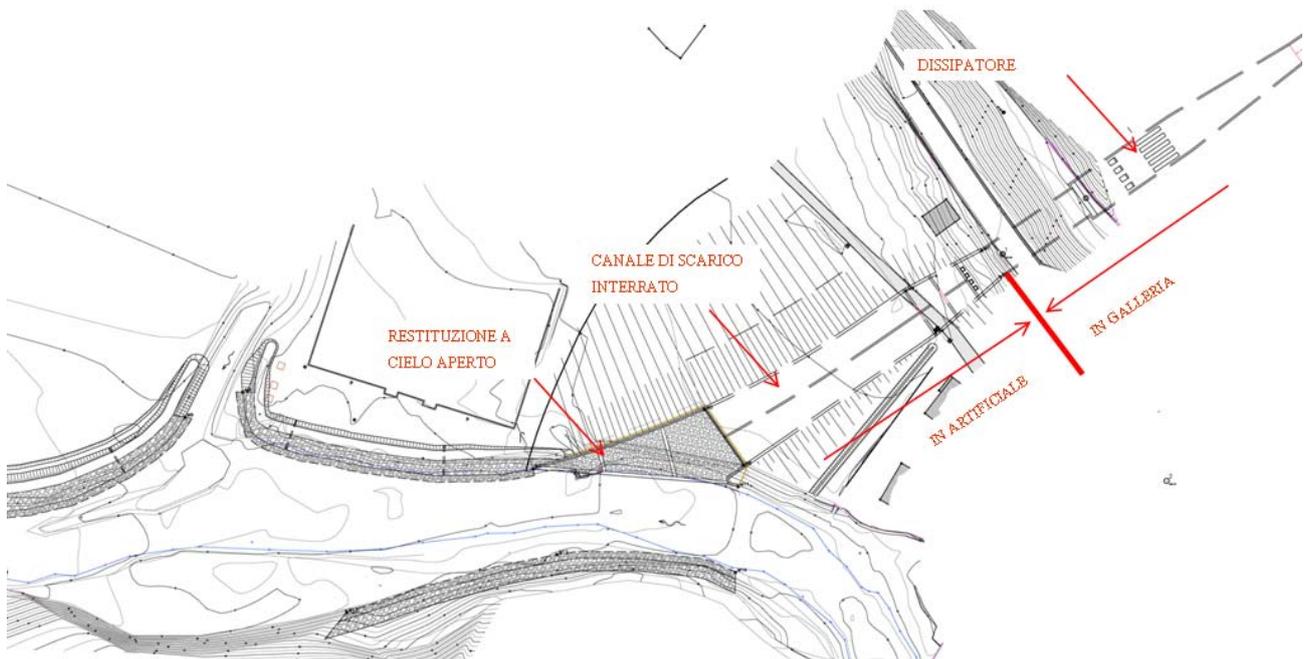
planimetria di inserimento opera di dissipazione e di restituzione
